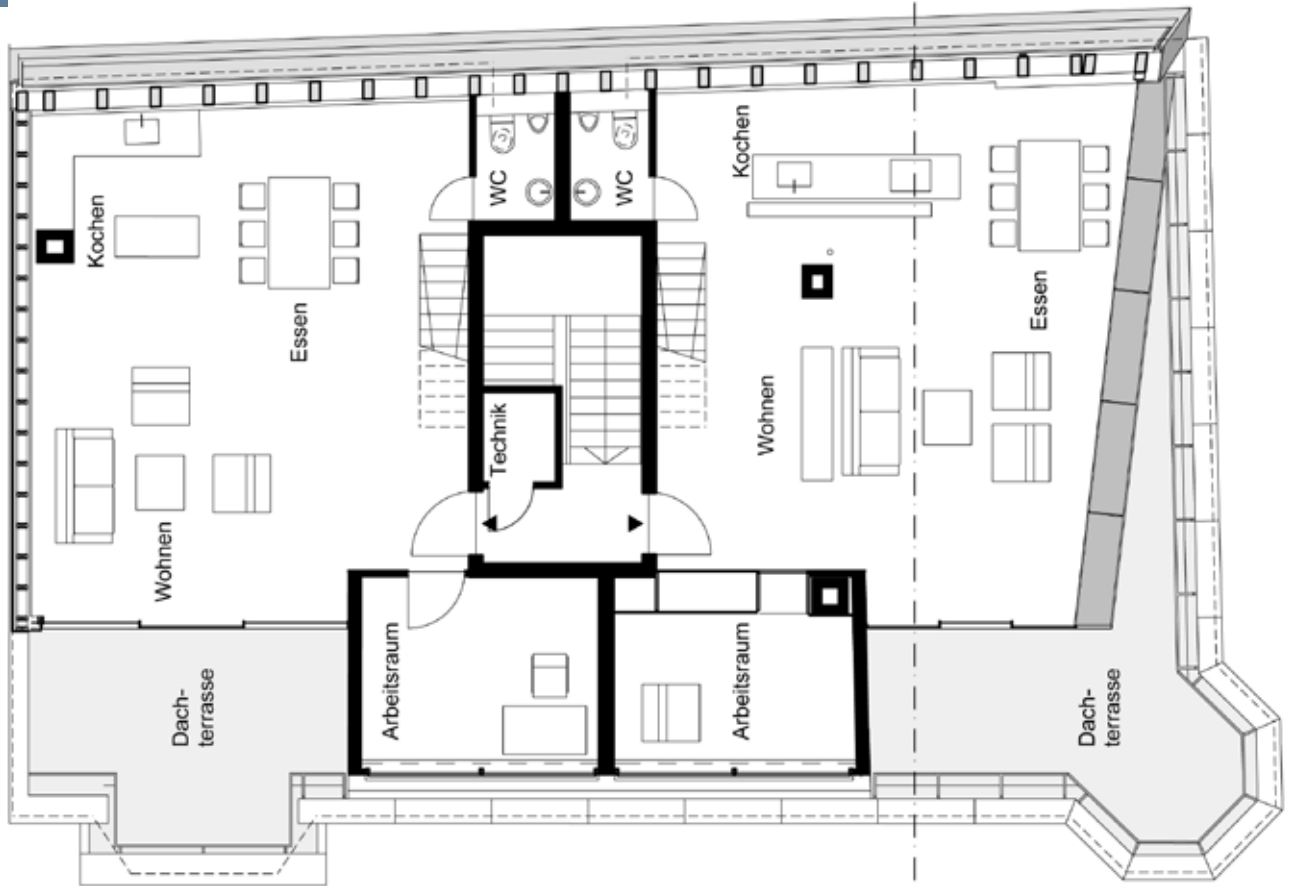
\_ Grundriss 1.DG © Danner Yildiz
